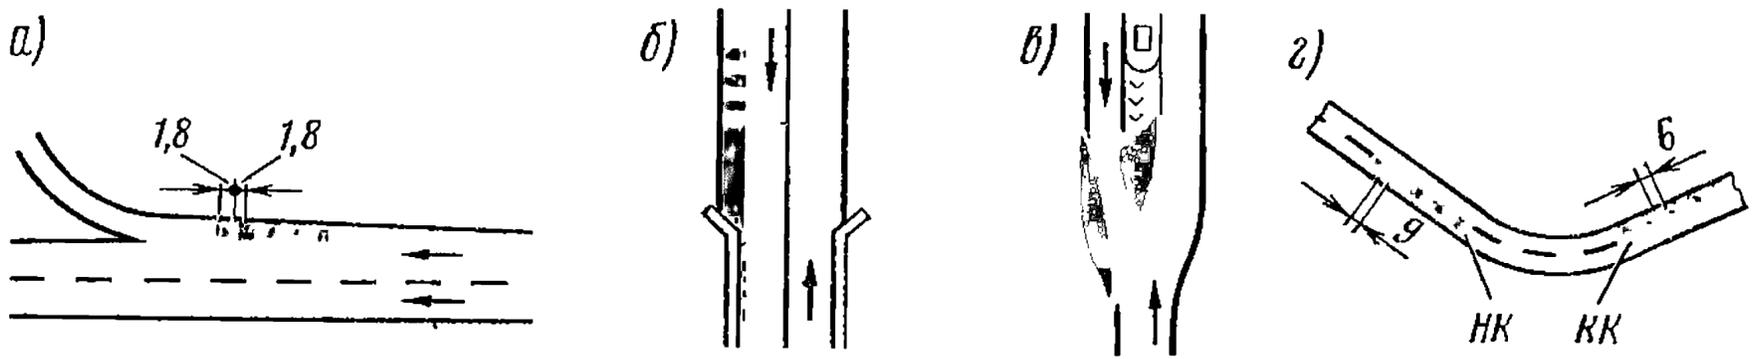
Схемы устройства на дорогах искусственных поперечных полос для создания тряски:
